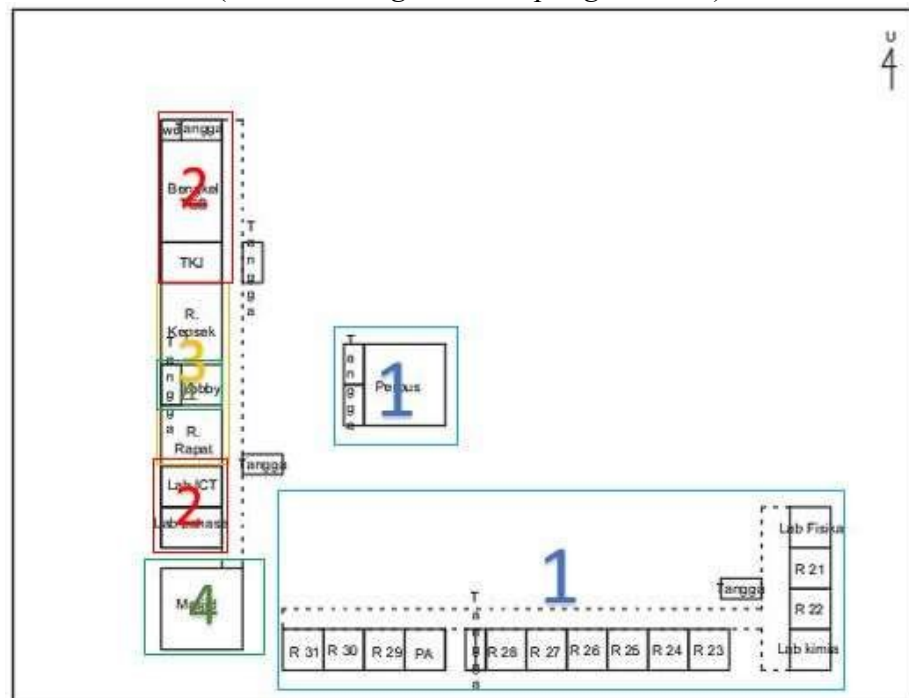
Denah Bangunan Lantai 2 di SMK Negeri 2 Klaten
